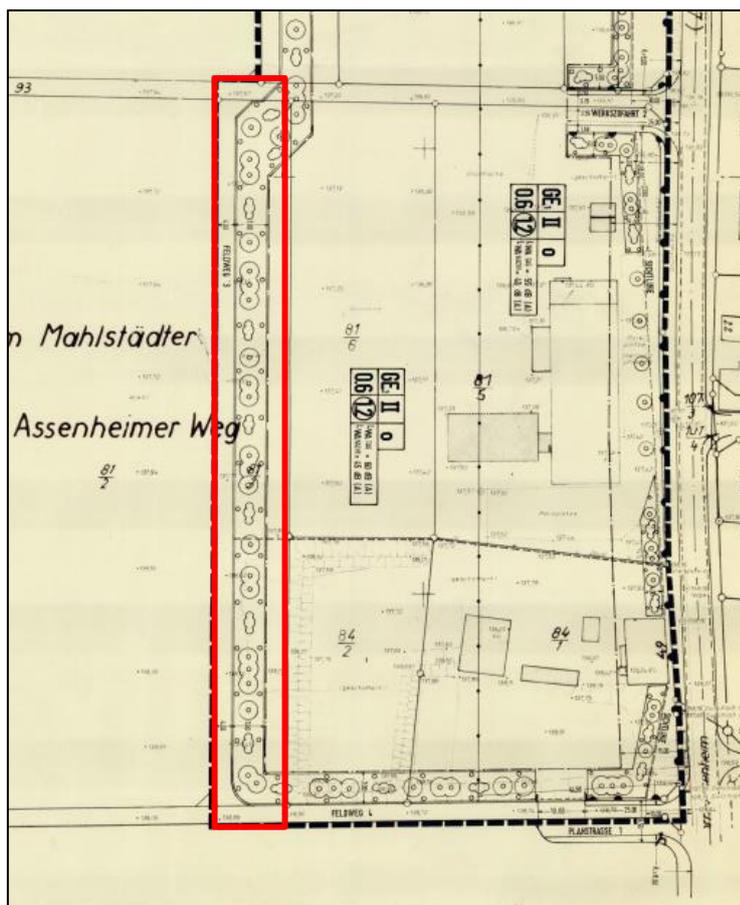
Ausschnitt aus dem rechtskräftigen Bebauungsplan „Am heiligen Stein – Teil B“ – 1. Bauabschnitt
